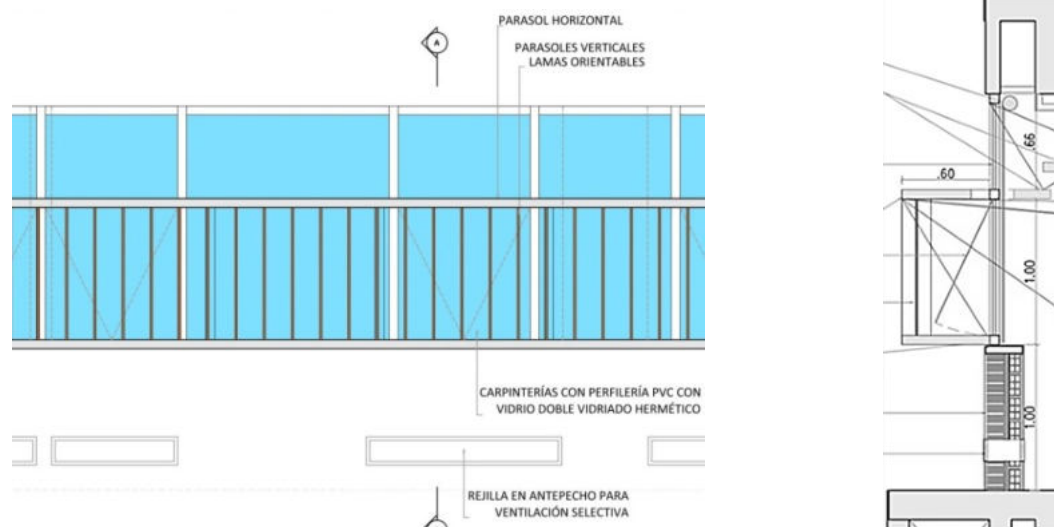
Detalle Vista parasoles verticales móviles (y correlativo corte).
